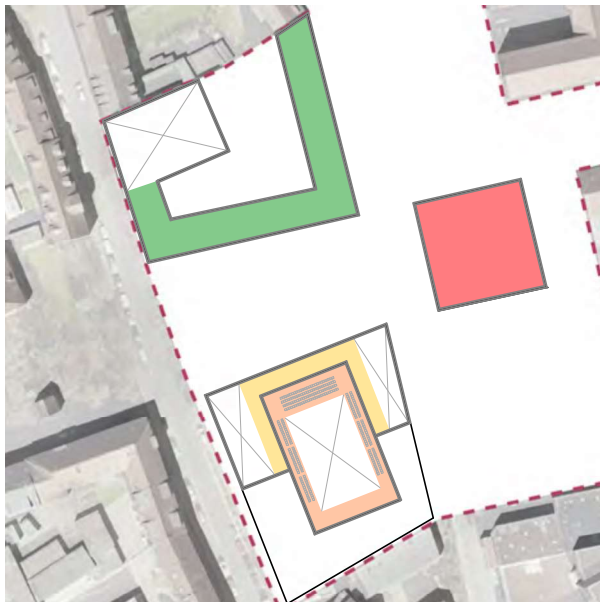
Grundriss OG2 Großer Hof V2
